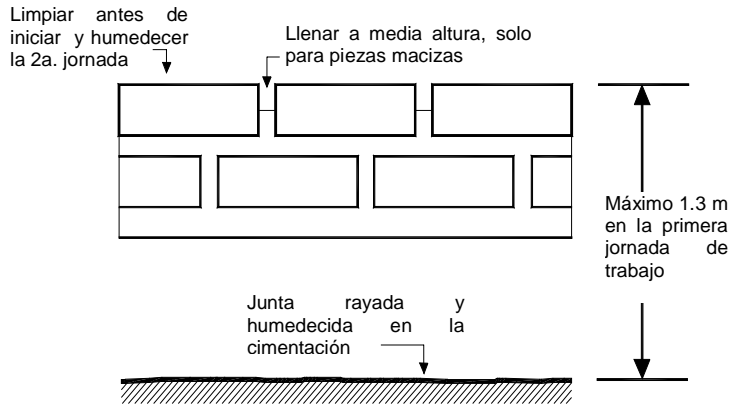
Juntas de construcción (San Bartolomé, 1994)
